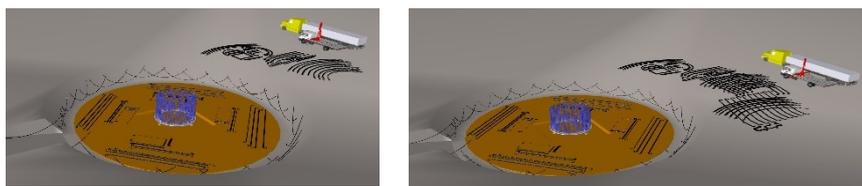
Descarregamento da 2ª e 3ª carreta respectivamente
